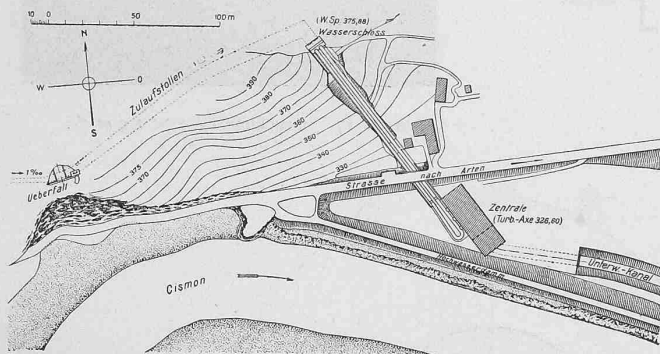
Lageplan vom Ueberfall bis U.-W.-Kanal. — 1 : 4000.
